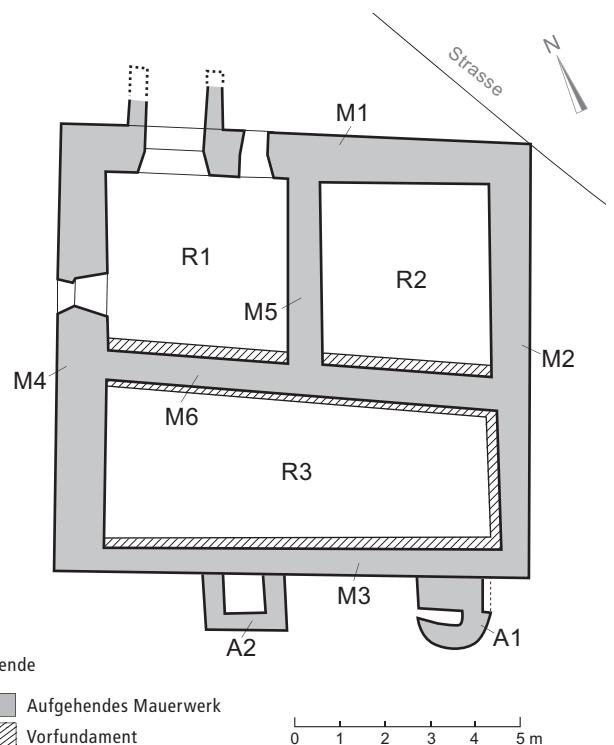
Steinmaur. Sünikon. Grundriss der Ruine im Pflasterbach (aus: Zürcher Denkmalpflege, 3. Bericht, 1. Teil, Steinmaur, Pflasterbach 1962/63 [Zürich 1967], Plan 7, Beilage 8).
